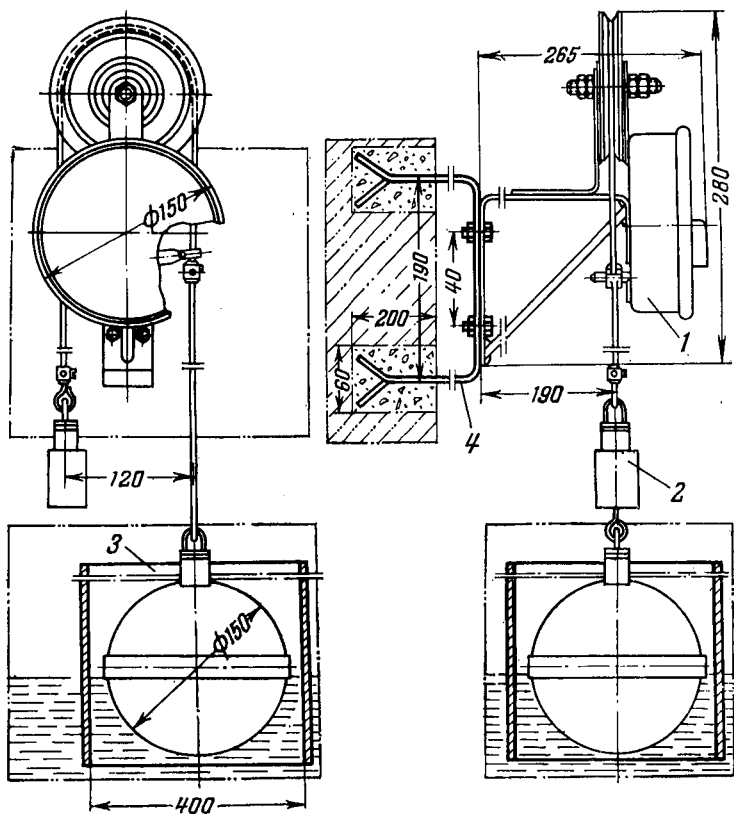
Установка поплавкового реле типа РМ-51.
